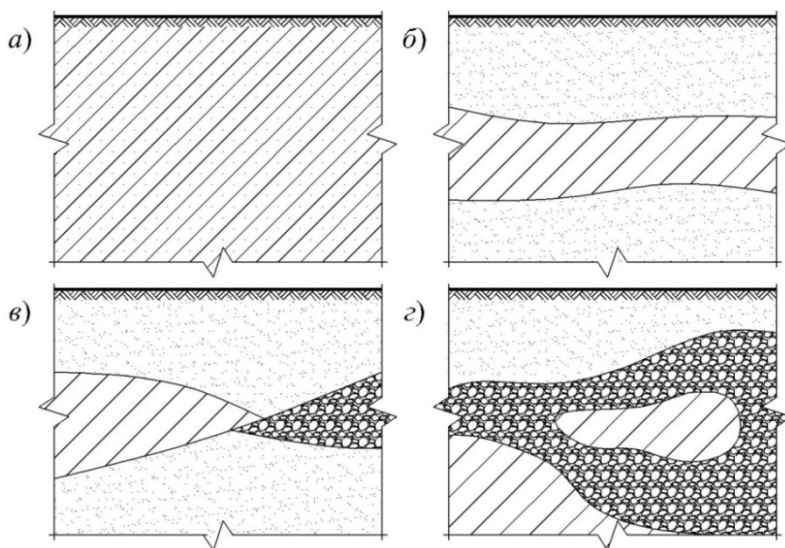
Схемы основания с различным напластованием грунтов:
